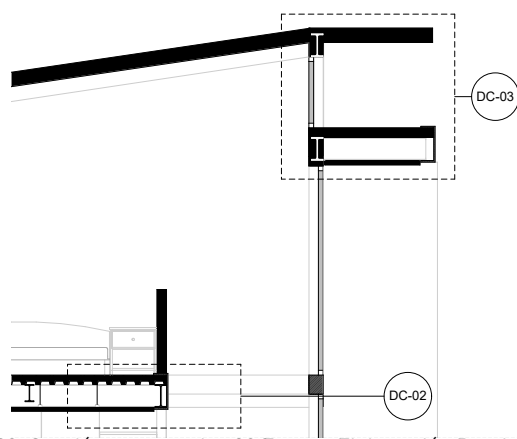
Sección constructiva 02 Fuente: Elaboración Propia
